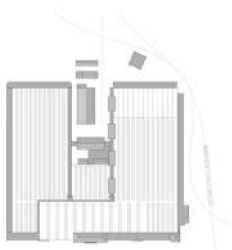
Rzut dachu fabryki Scheiblera z 1889 roku [opracowanie własne]
